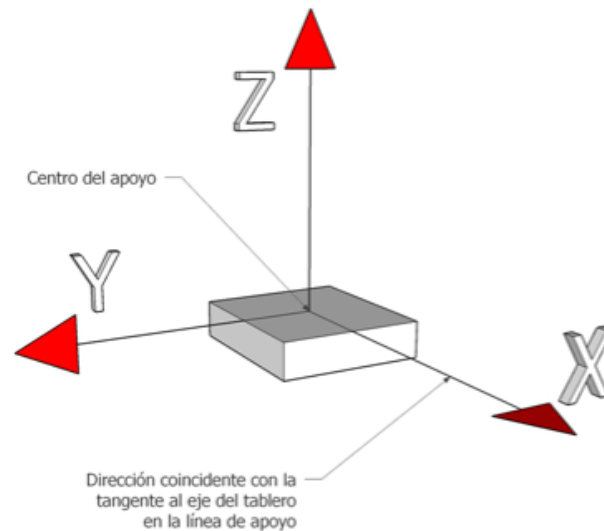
Componentes de acción en apoyo elástico, (CYMPER, 2016)
